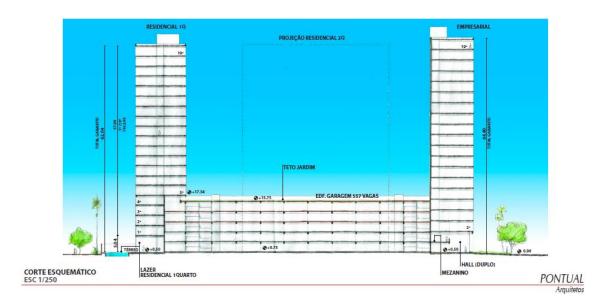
Corte esquemático da nova proposta. Fonte: Autor do Projeto
